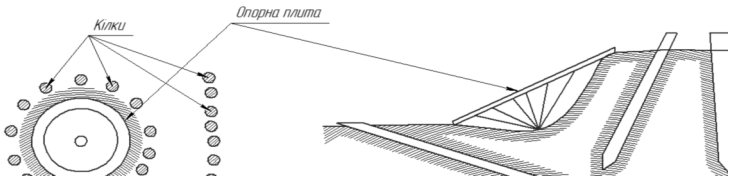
Установлення опорної плити на ґрунті, укріпленого кілками
